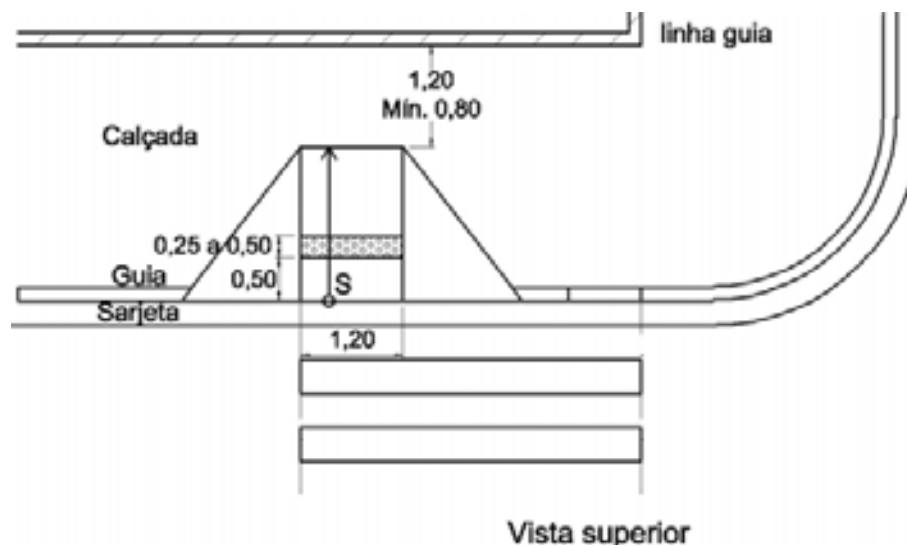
Sinalização tátil nos rebaixamentos de calçadas
